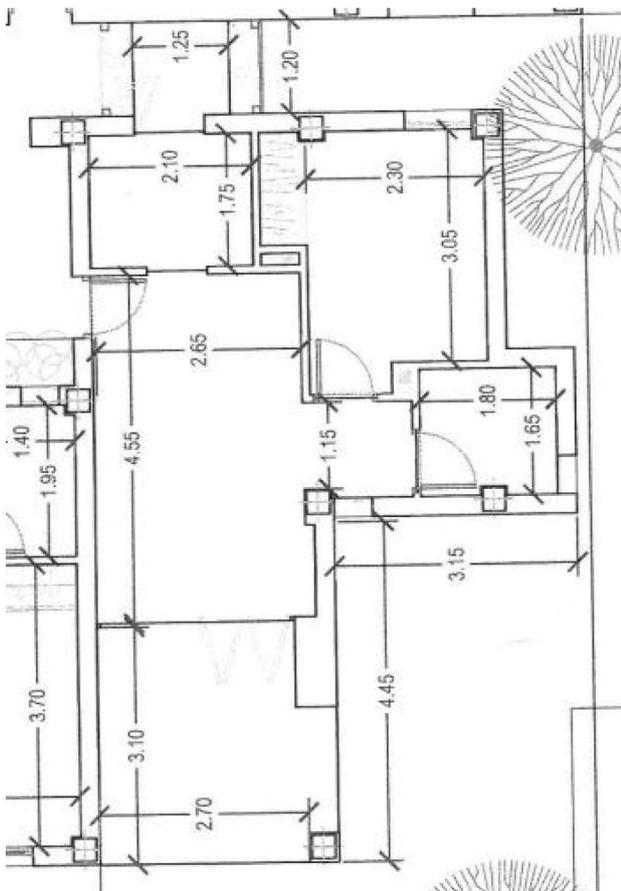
Stralcio della pianta del piano terra del progetto di cui al Permesso di Costruire n° 10 del 27/06/2007
